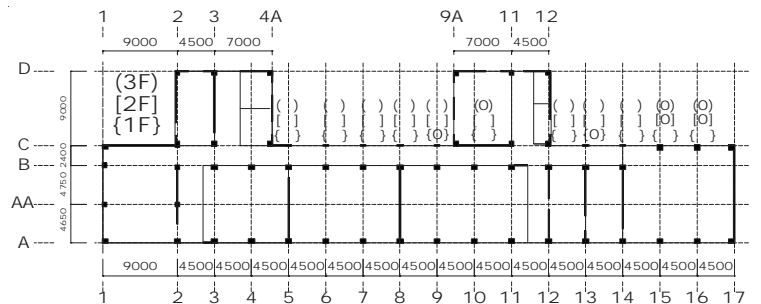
平面図と鉛直部材損傷度 1階平面図
